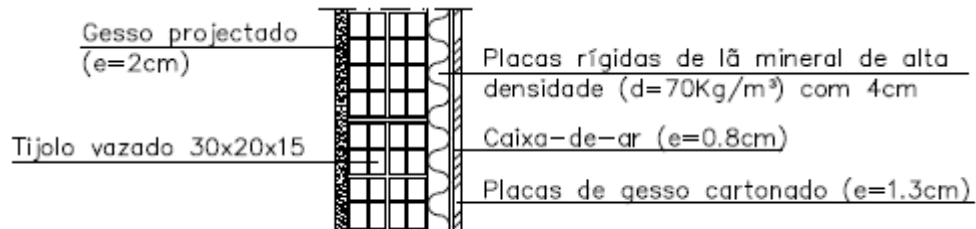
Pormenor da parede interior de separação entre a caixa de escadas e a habitação
